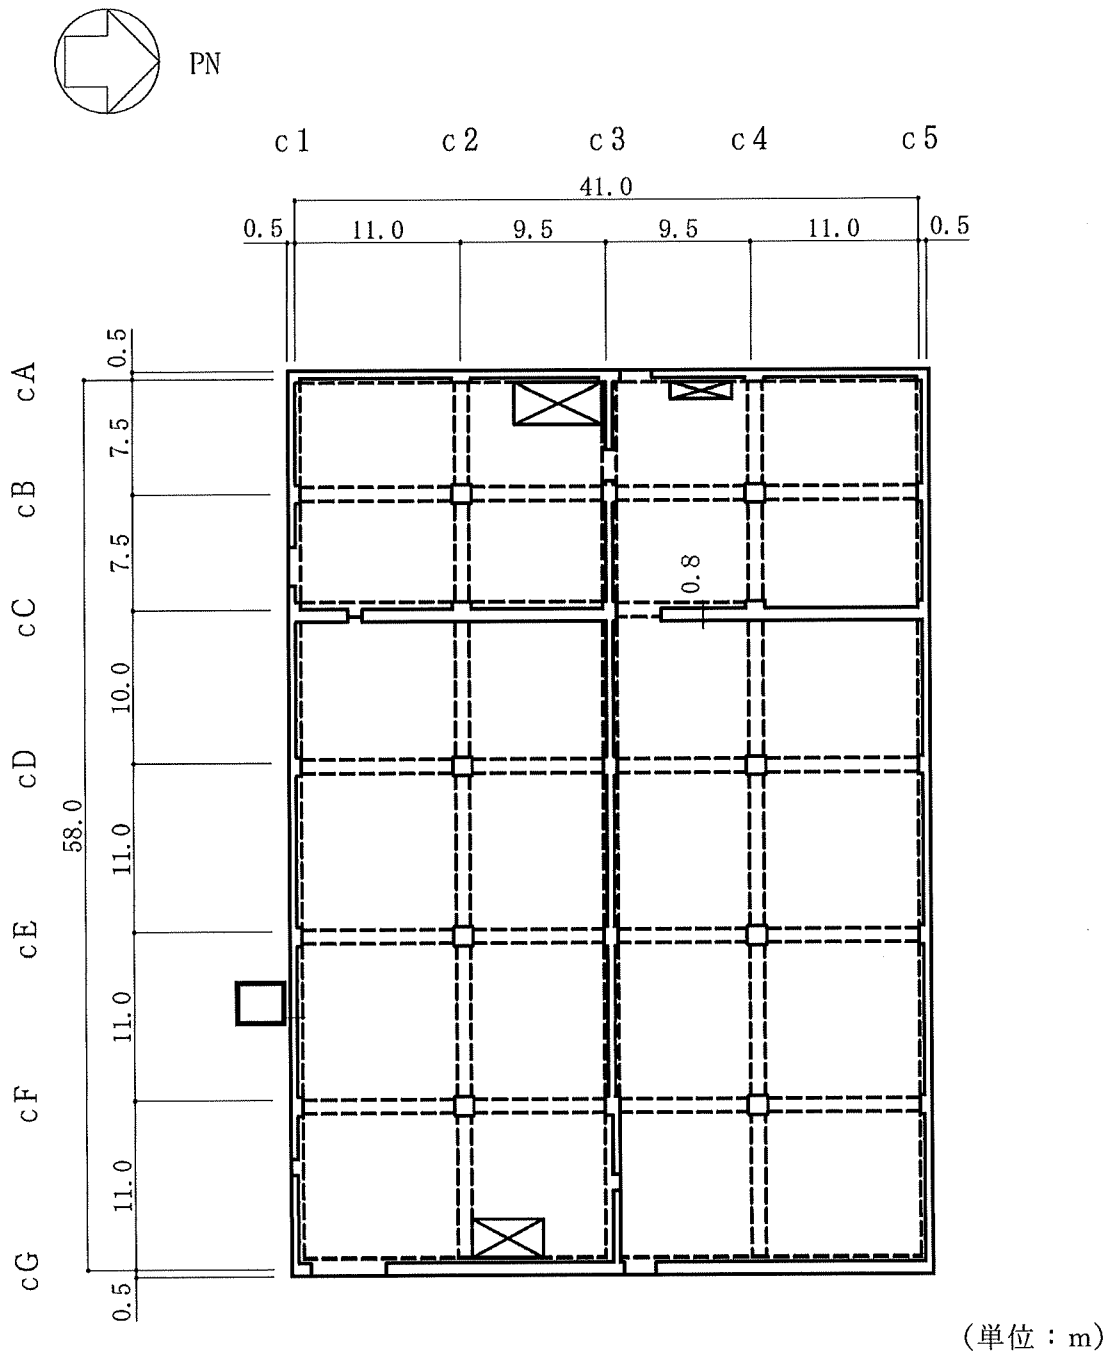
コントロール建屋の概略平面図 (1F, T. M. S. L. 12. 3m) (3/5)
